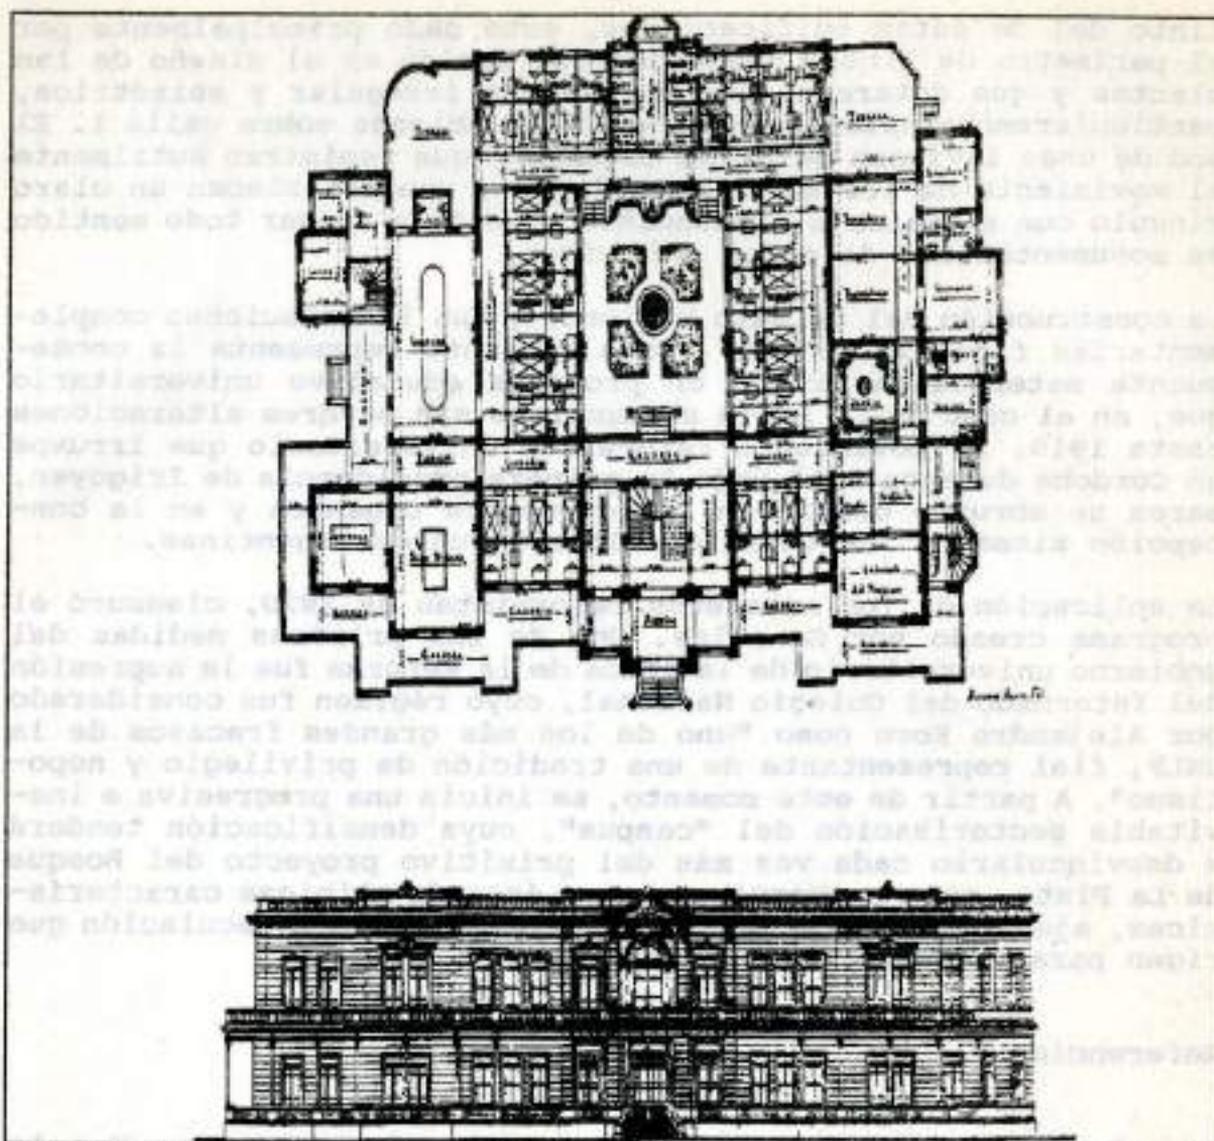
Colegio Nacional. Internado N°2. Planta baja y fachada sobre calle 47.
